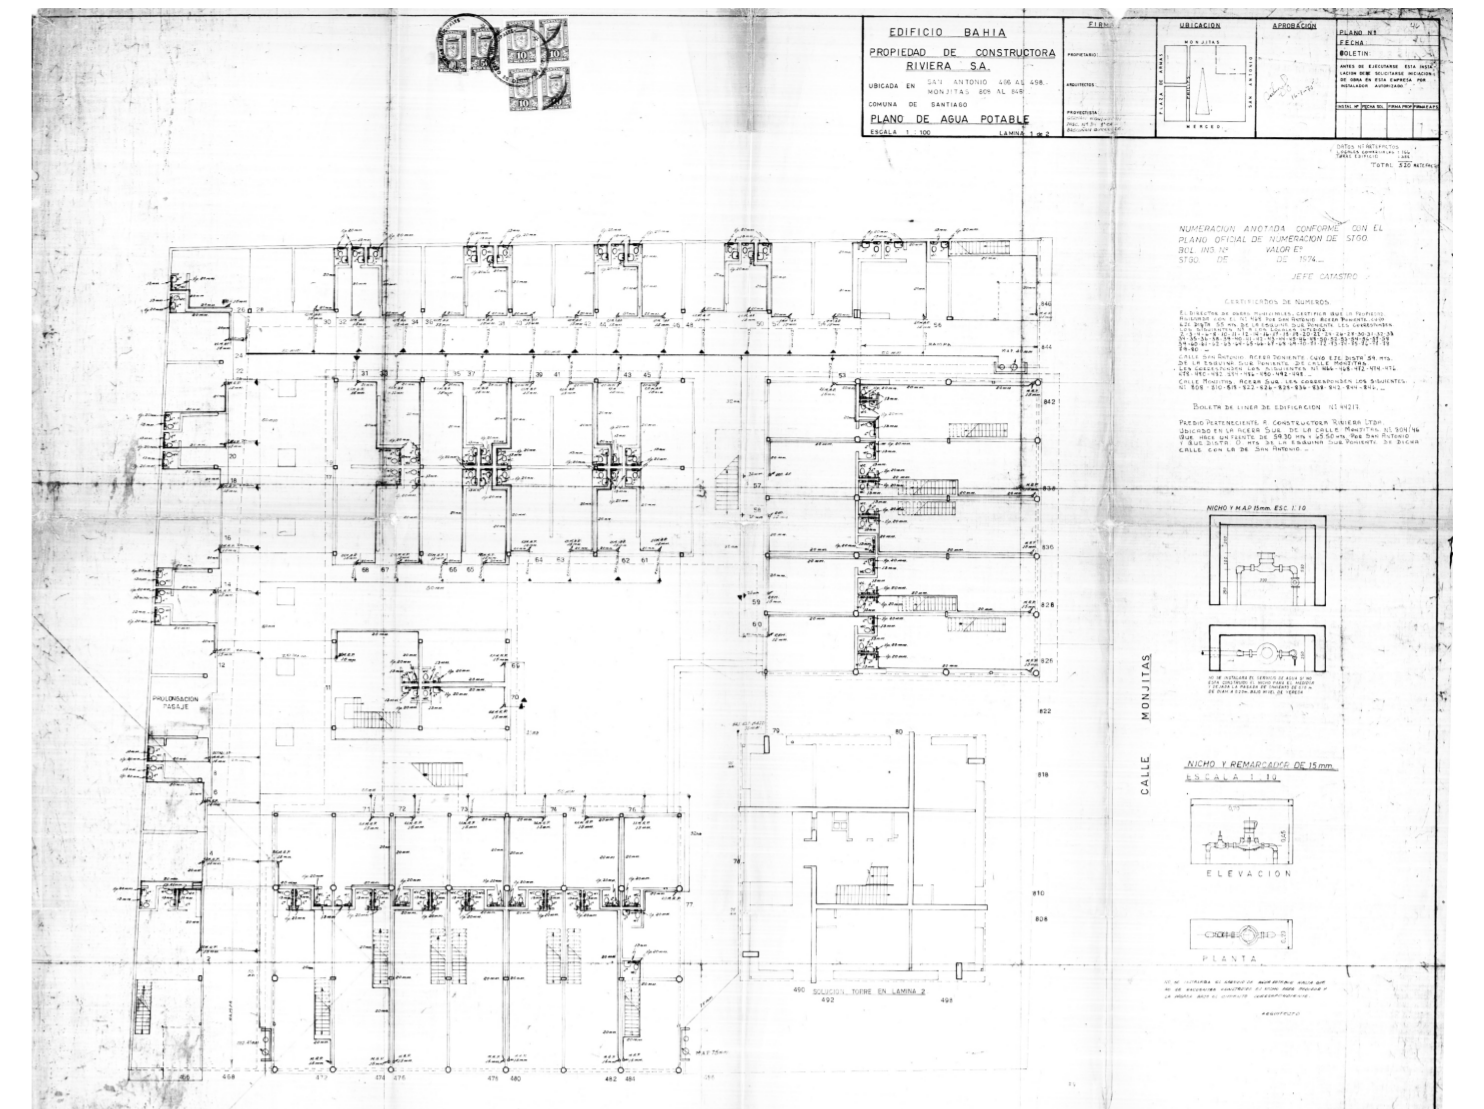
Archivo Plano Municipal. Planta instalación de agua potable.
